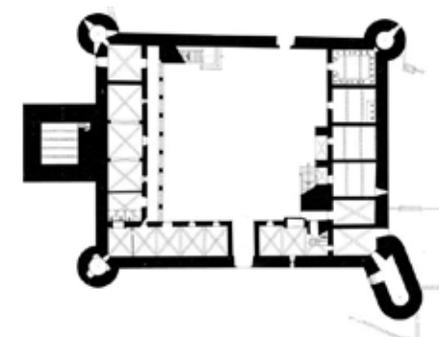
Castelo Novo de Vila Viçosa, Planta, 1520-37
